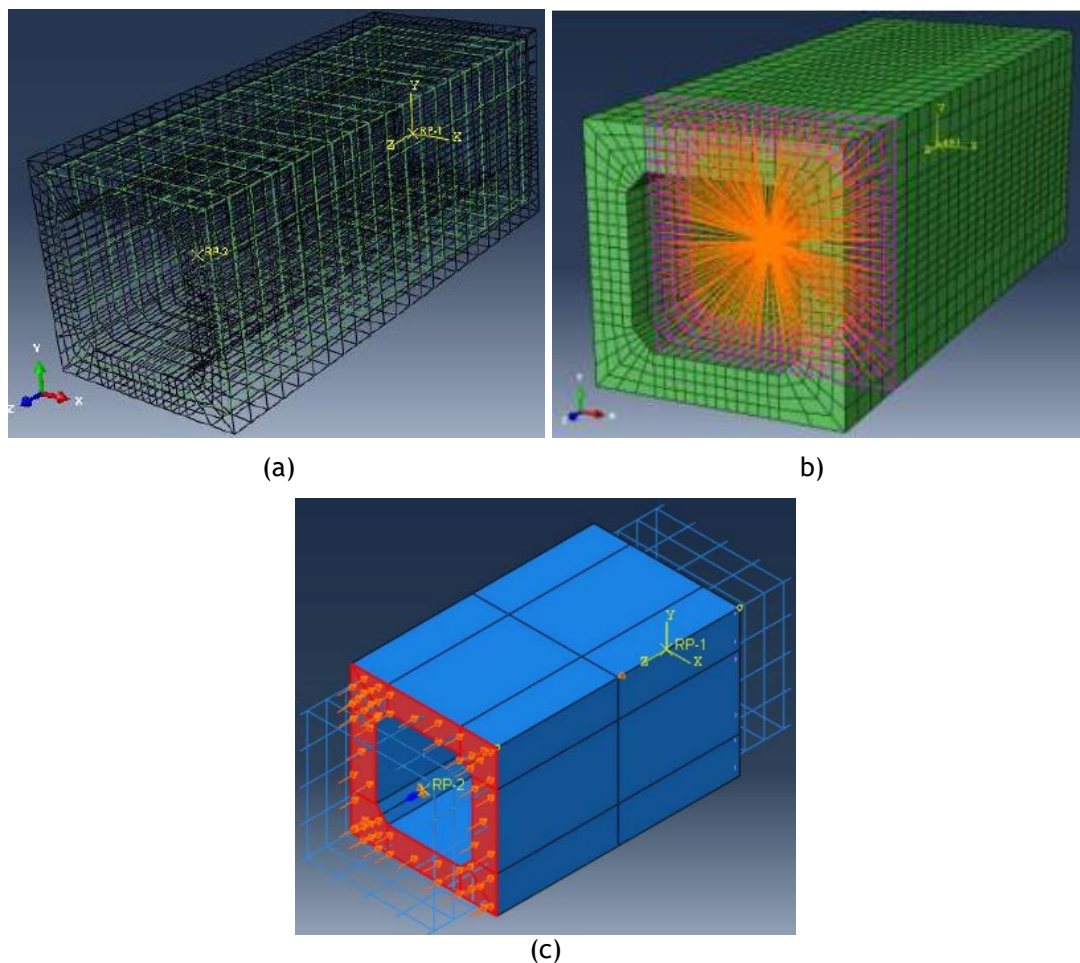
(a) Armaduras longitudinais e transversais no interior da viga, (b) Representação da limitação de acoplamento de um ponto de referência, (c) Aplicação da tensão axial uniforme, Abaqus [55]
